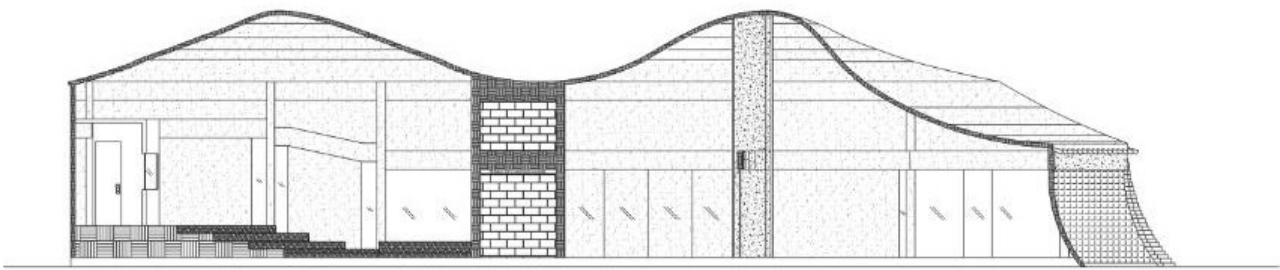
Corte longitudinal destacando um corte na nave central em concreto armado (desenho do autor)
